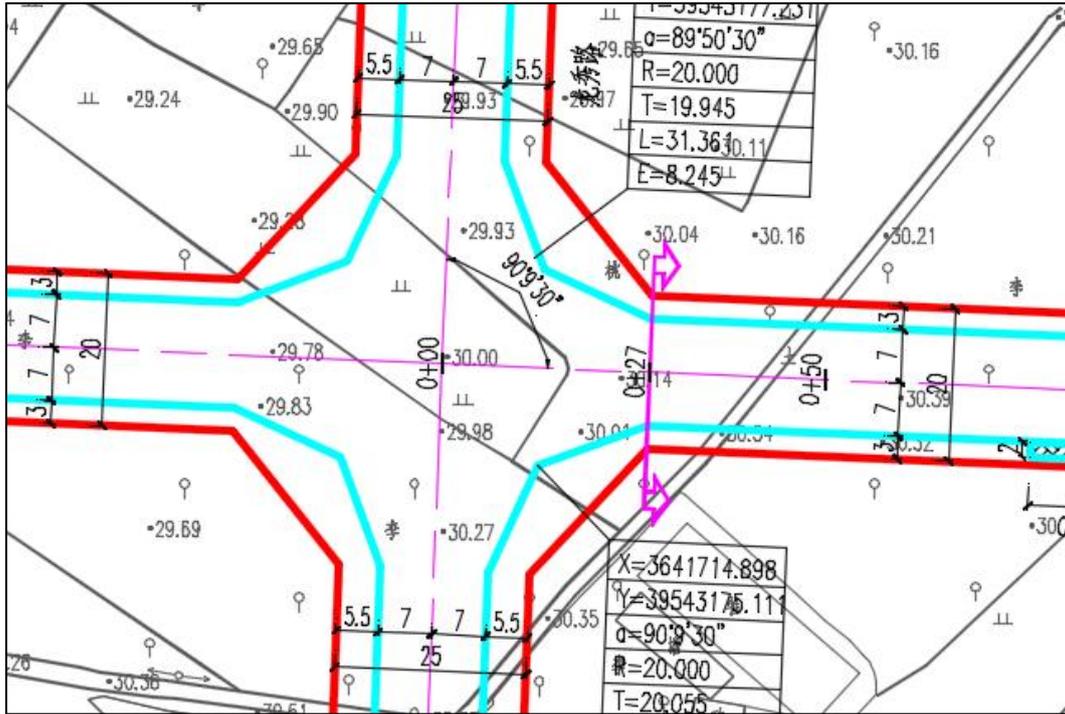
龙秀路与风乐路交叉口交通组织平面图
